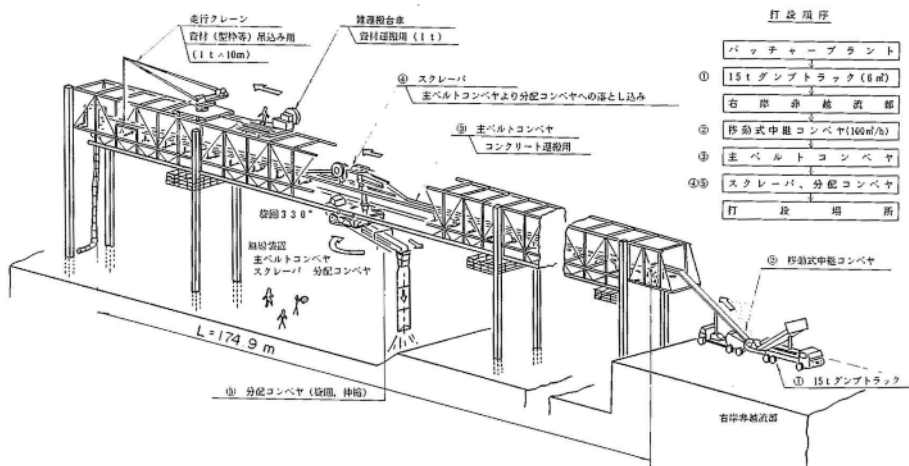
BCP工法による堤頂部コンクリート打設要領図(竜門ダム)
